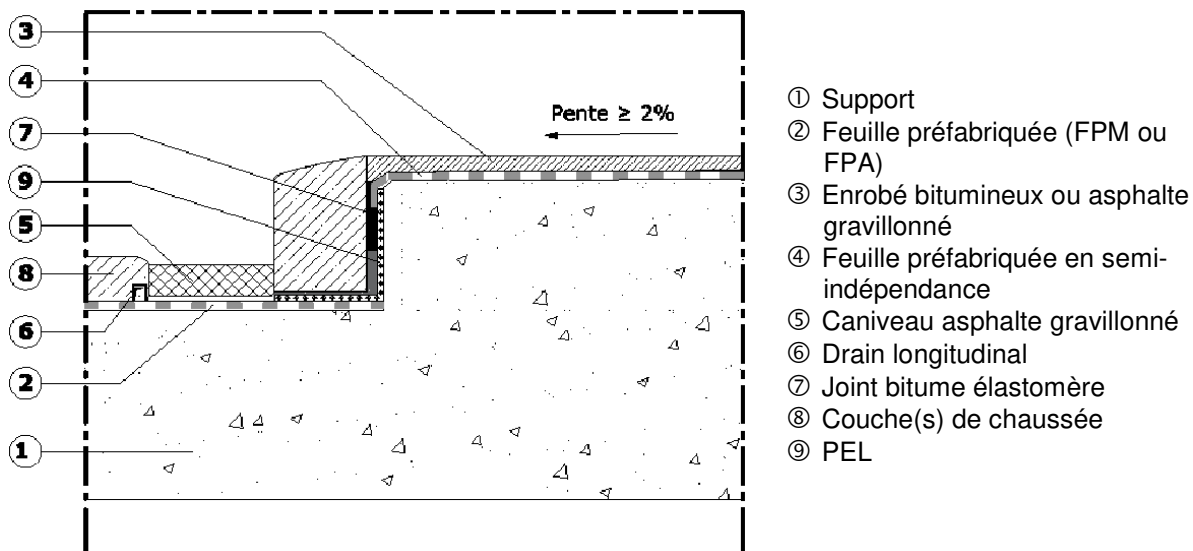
Détail de principe d'étanchéité avec feuille préfabriquée sur trottoir intégré à la structure
